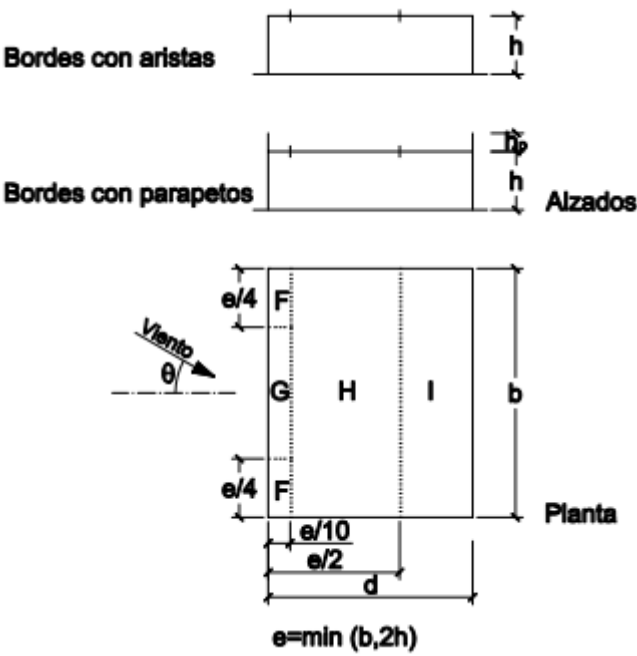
Tabla D.4 cubiertas planas, CTE DB-SE-AE, Anejo D.3
